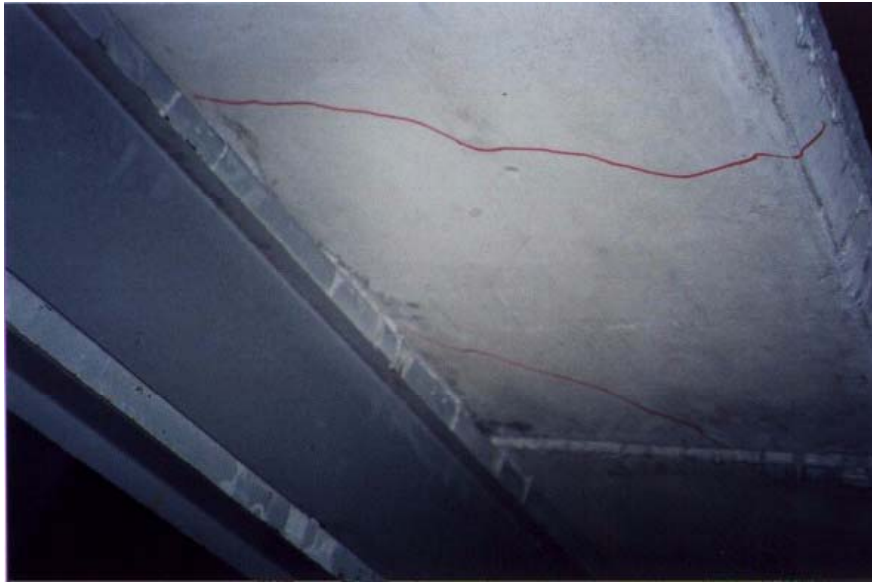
Fissuras na face inferior da pré-laje (Modelo 4).
